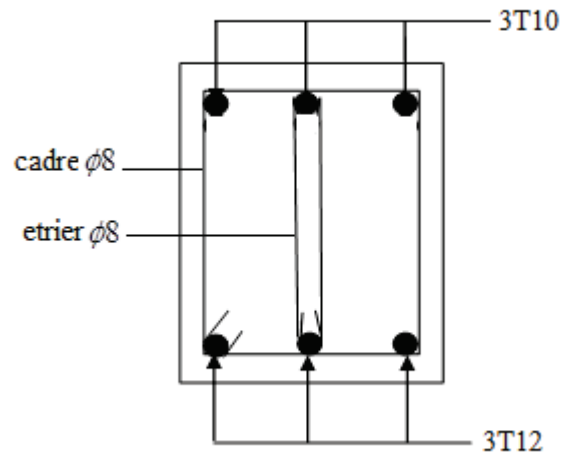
Schéma de ferrailage de la poutre de chaînage
